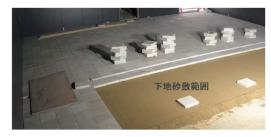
T-e Concrete® コンクリート平板敷設時の状況
